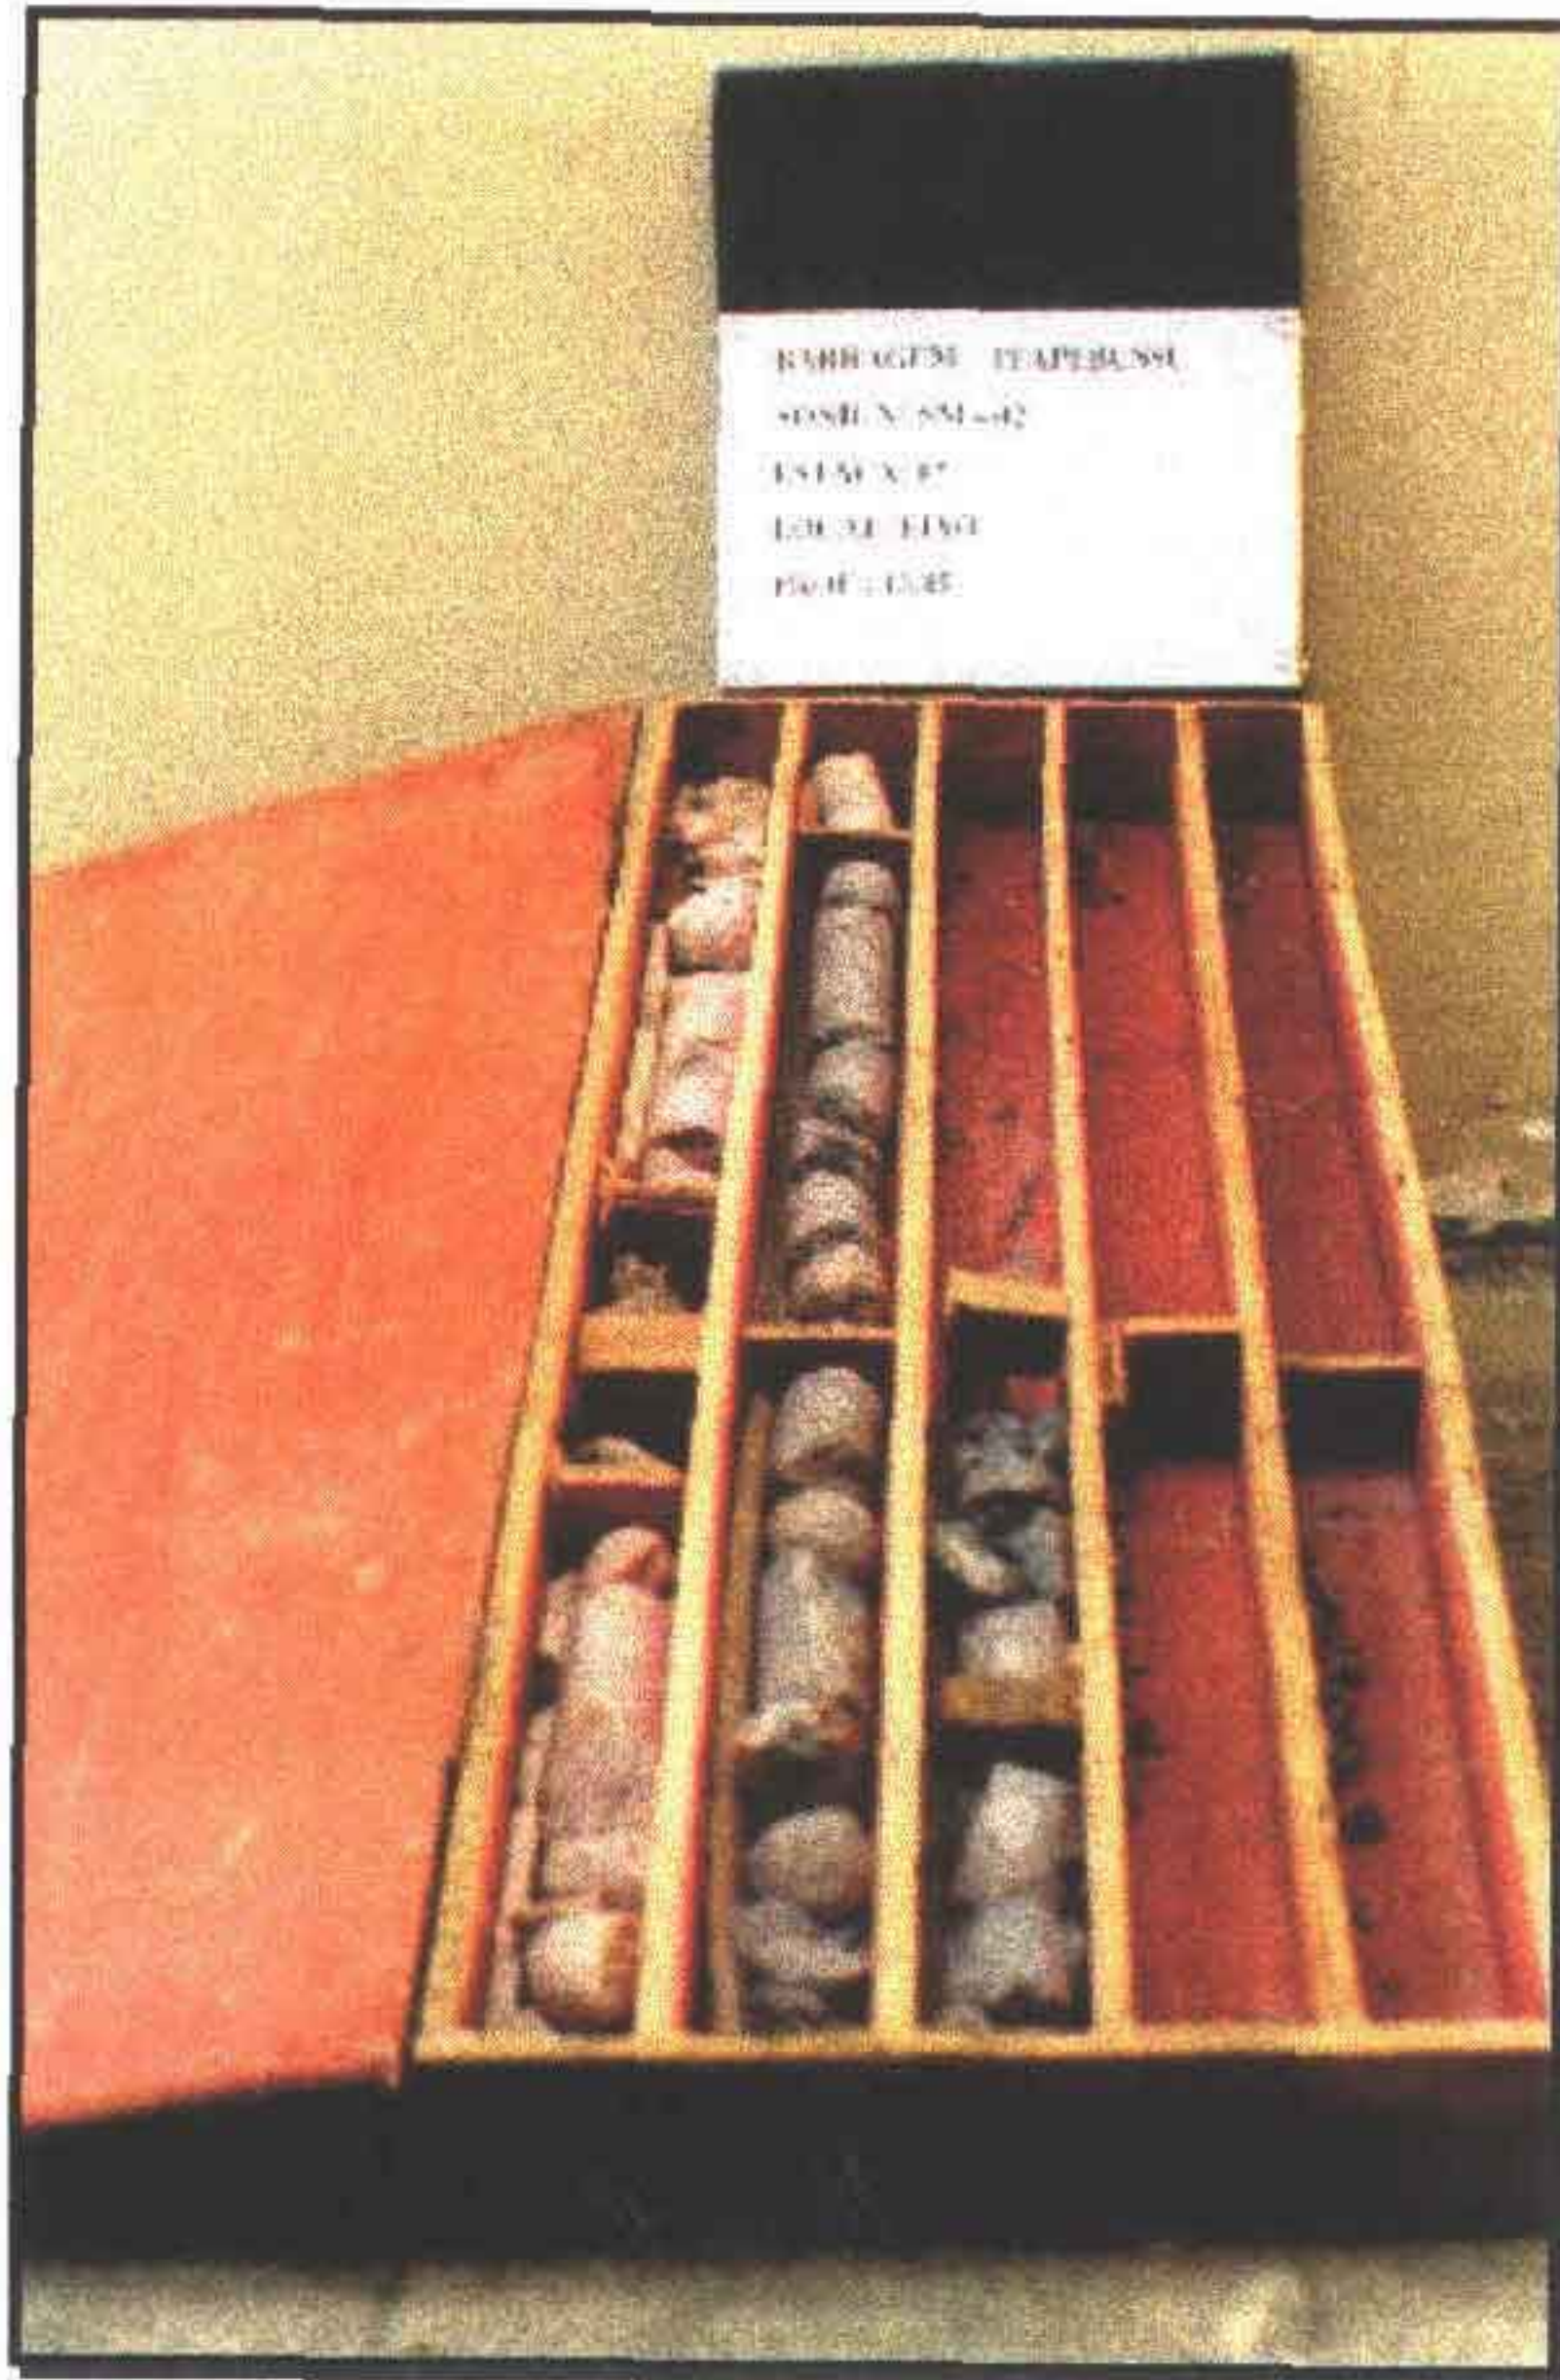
Testemunho de rocha da sondagem SM – 02.
